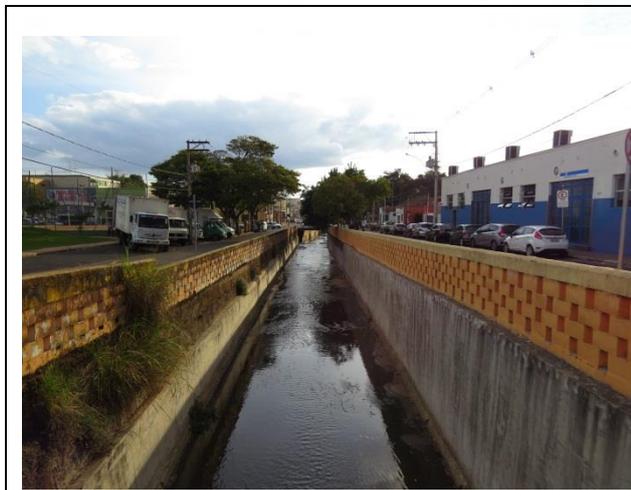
Vista, de montante para jusante, de trecho retilíneo e retificado do córrego Gregório. Notar dimensões da margem e do leito da drenagem.
